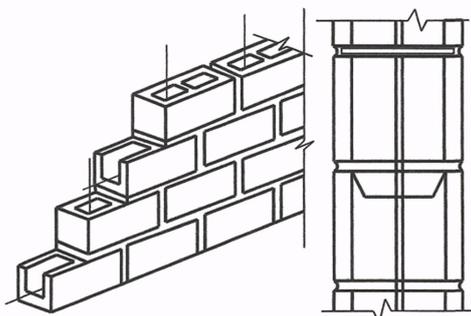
Расположение вертикальной и горизонтальной арматуры в пустотах блоков
